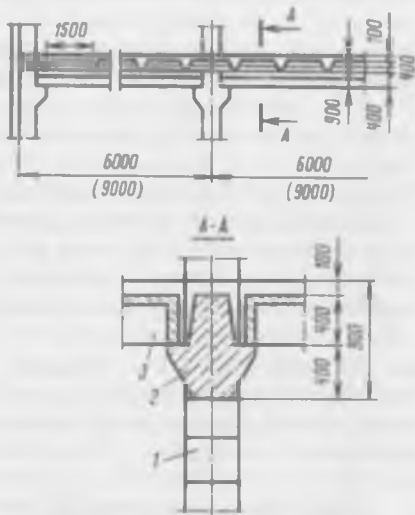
Сборное железобетонное перекрытие (тип II):
